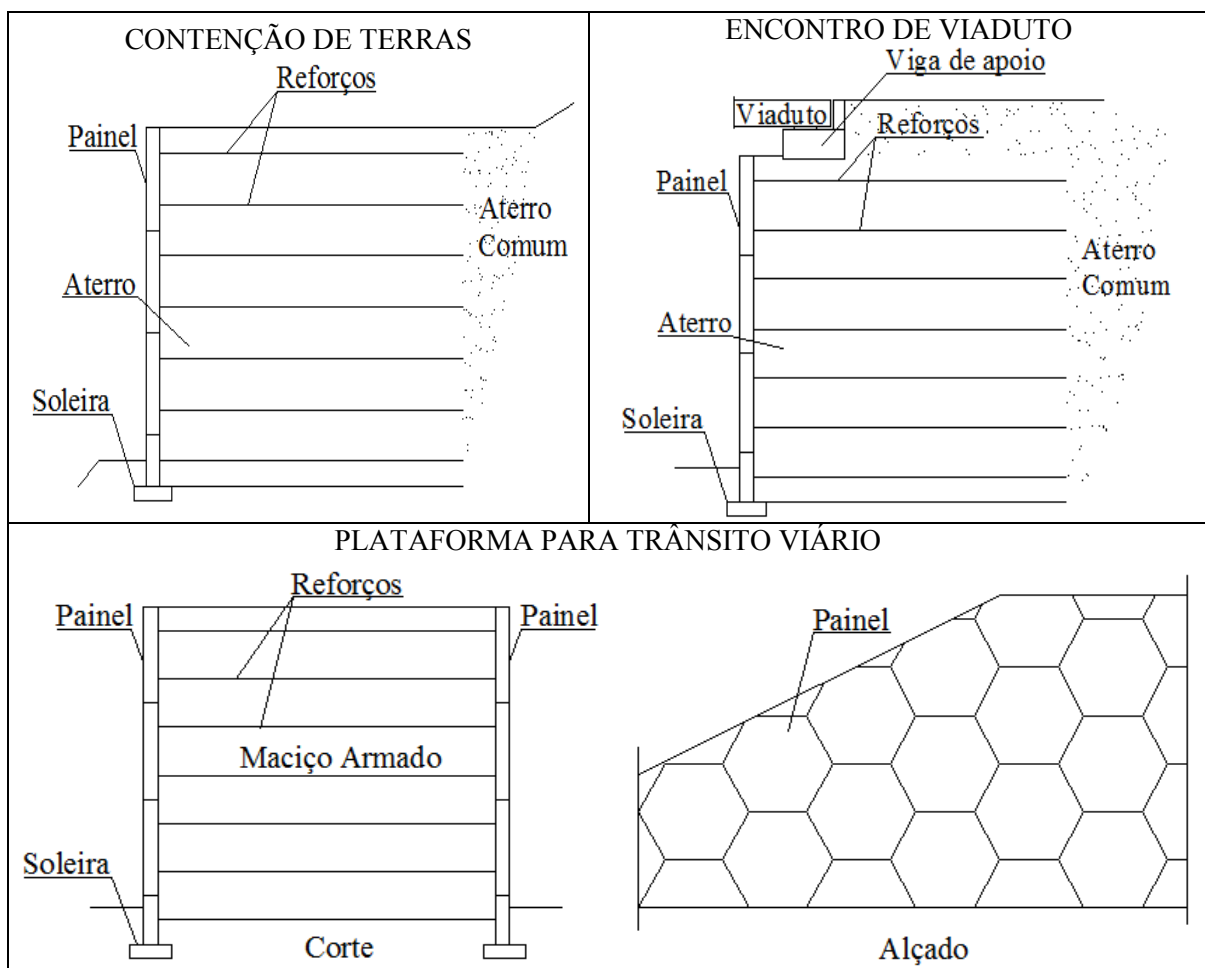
Aplicações da Terra Armada 1 (adaptado de Félix, 1991)
